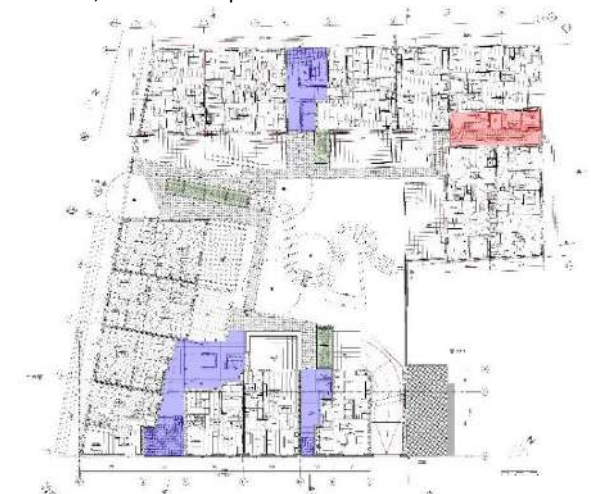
En bleu hall d'entrée des acquéreurs, en rouge hall d'entrée des locataires sociaux (fond de plan issu de ADRIANA, annotations personnelles)
